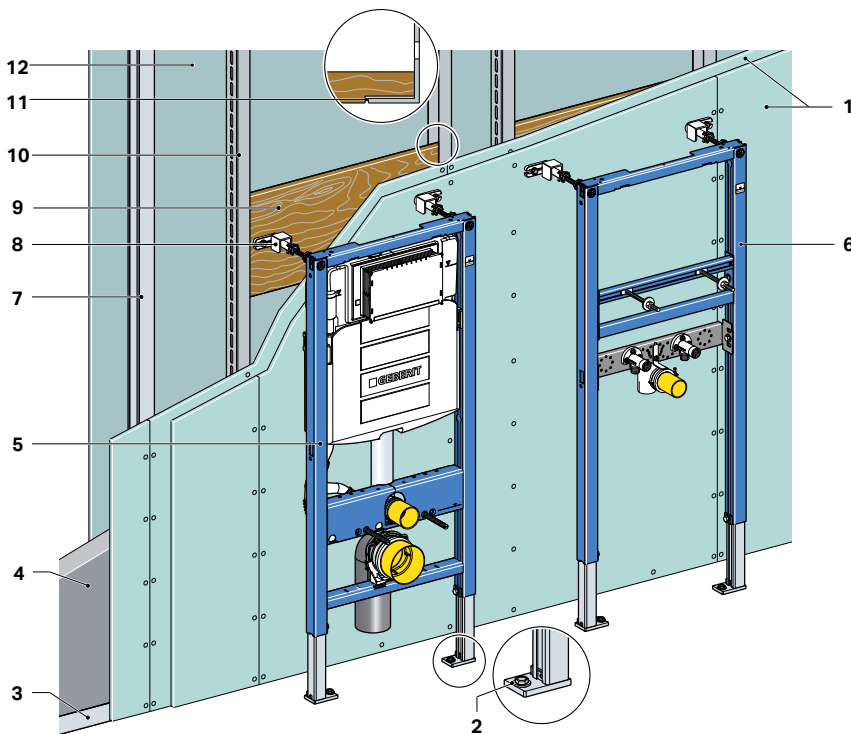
Duofix Einzelemente vor einer Trockenbau-Einfachständerwand
